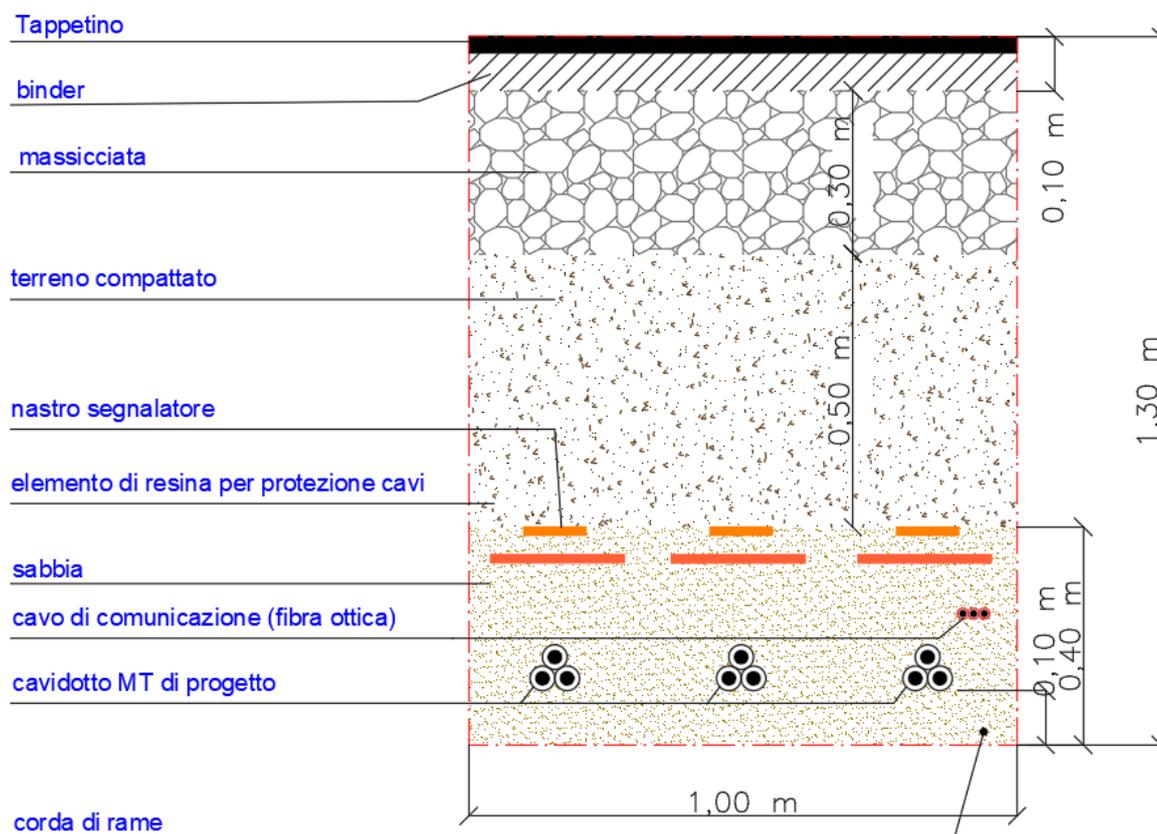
Sezione Cavidotto doppia terna di cavi su Strada Bianca
